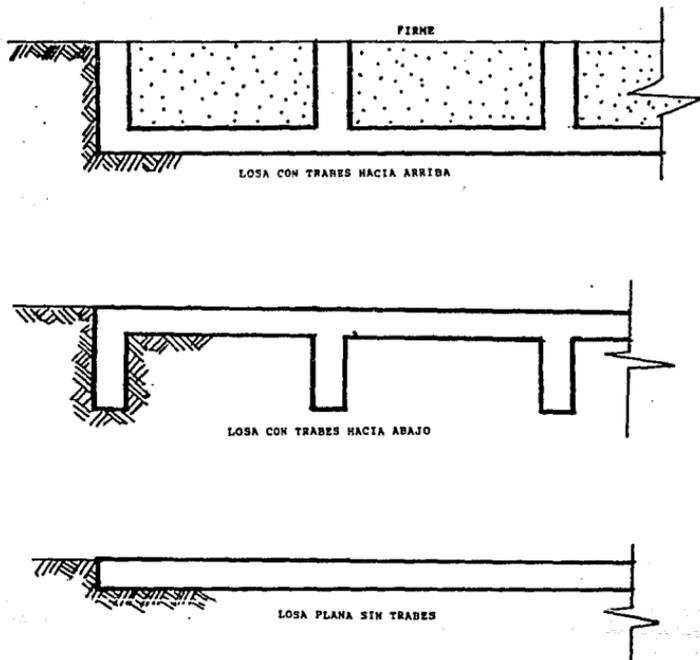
LOSAS CON TRABES HACIA ARRIBA, HACIA ABAJO Y PLANA
